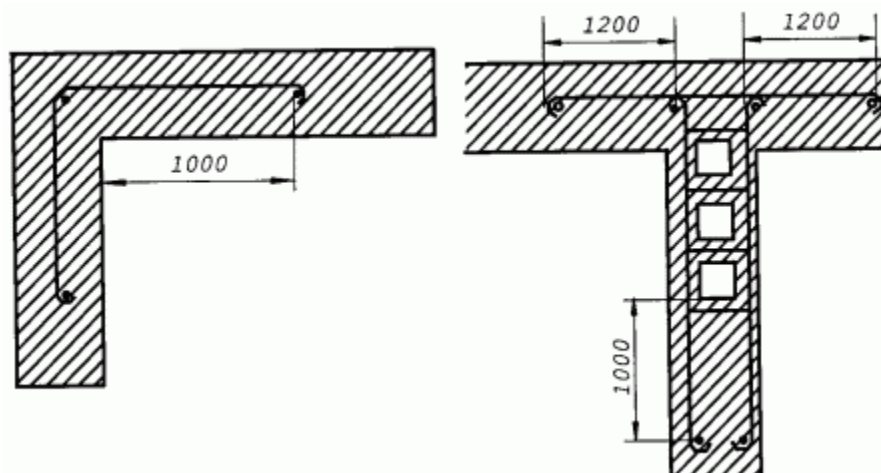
Укладывание стальных связей в углу и примыкание внутренней стены к наружной.
